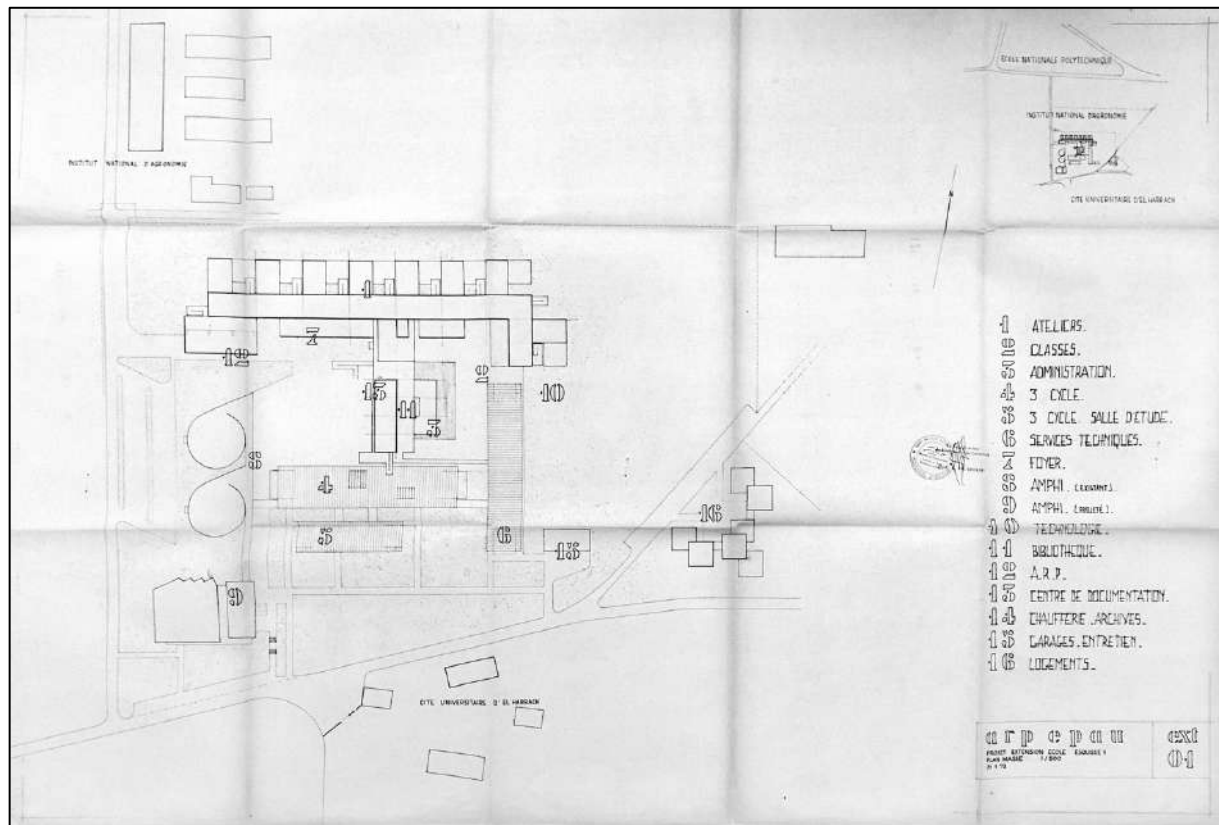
Projet d'extension de l'EPAU. Esquisse (31 janvier 1973). Plan RDC. Fonds Deluz. Boite 69, chemise 9.
